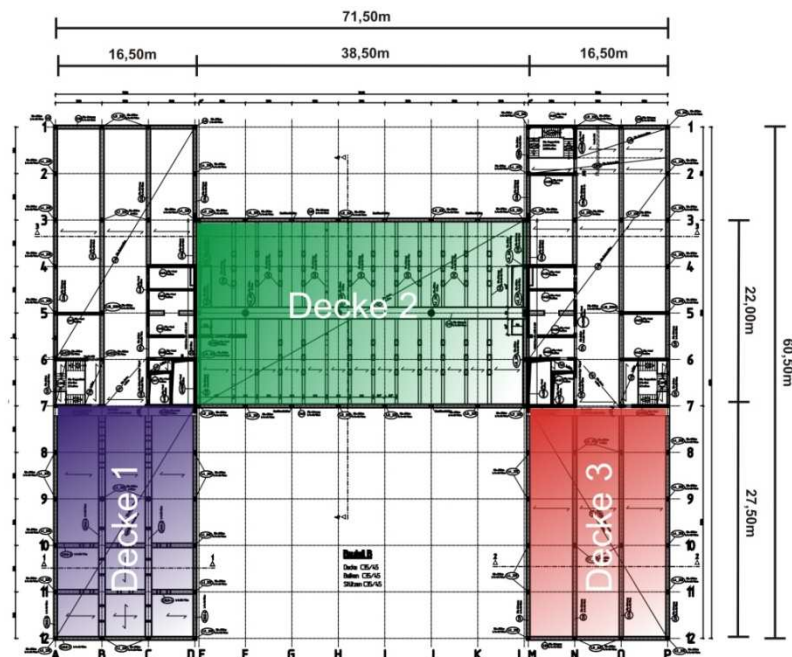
Grundriss des dritten Obergeschosses – Untersuchtes Objekt: Decke 3
